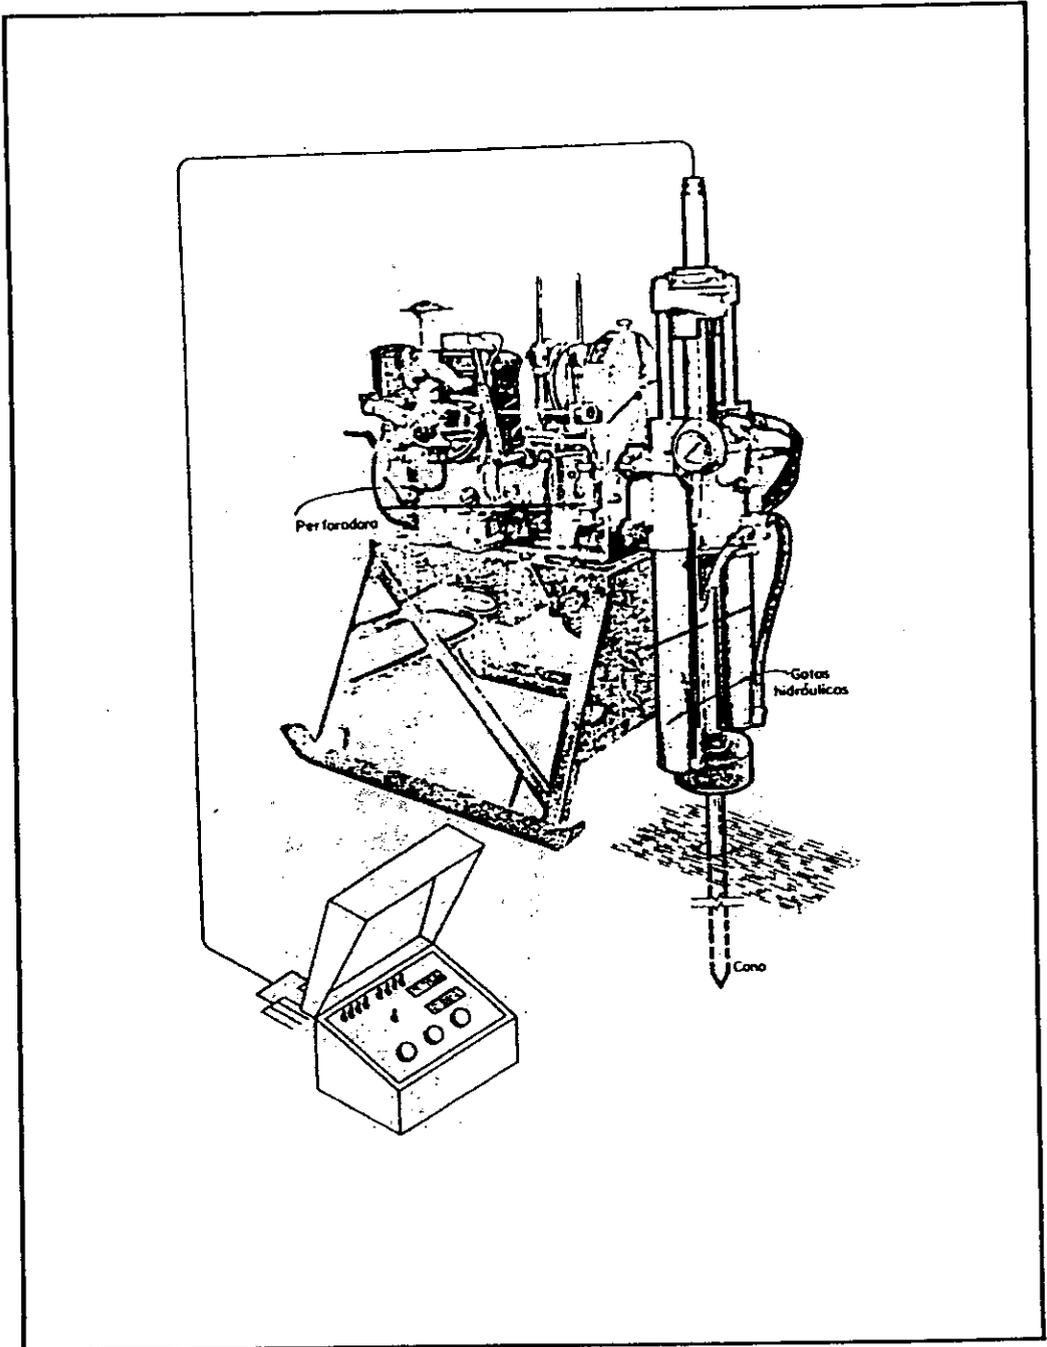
MECANISMO PARA CONO ELÉCTRICO.
